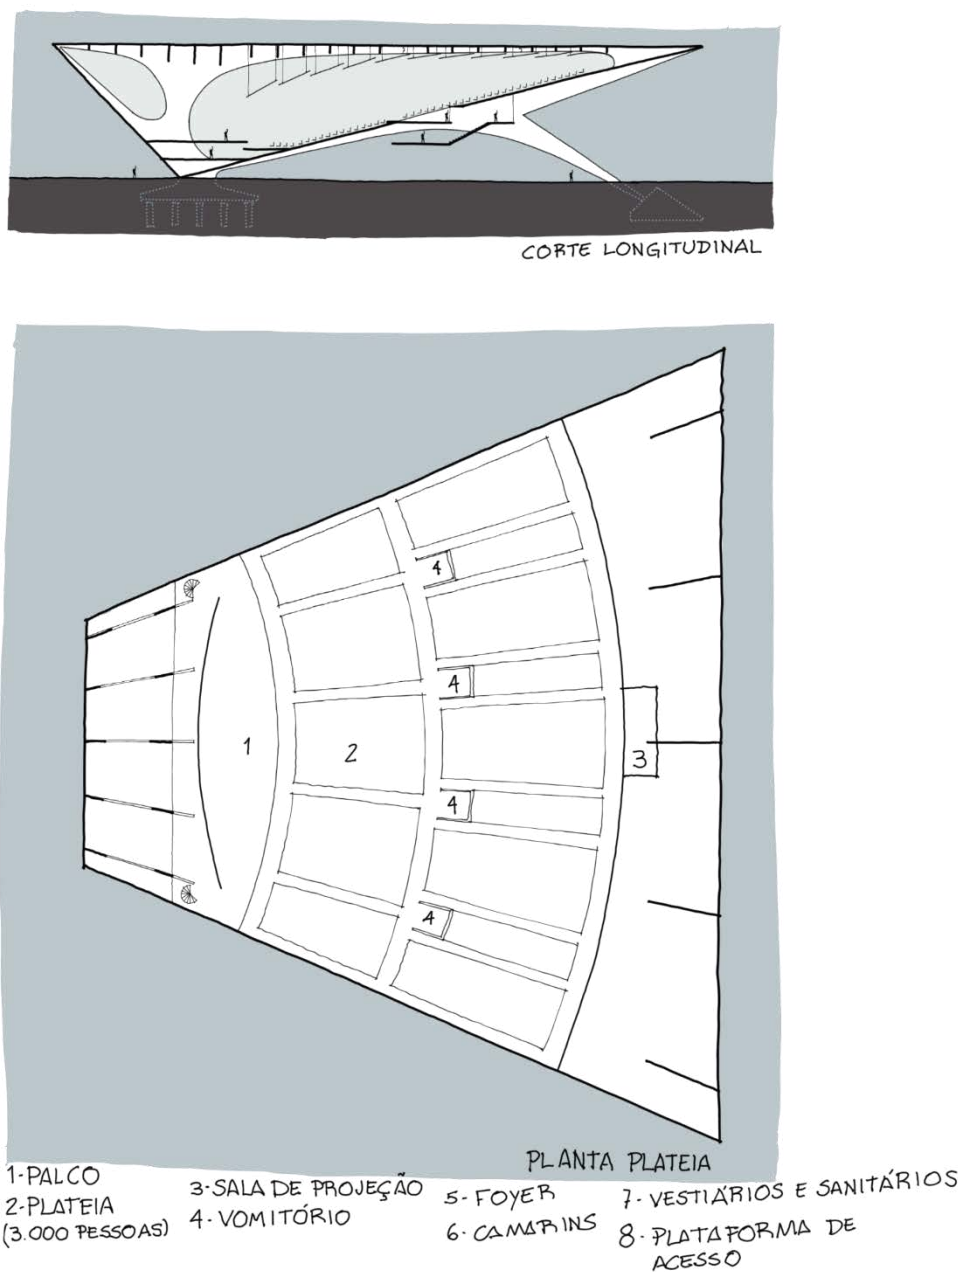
Corte e planta da plateia completa – desenho nosso – fonte: (NIEMEYER, et al., 1952 p. 9)
